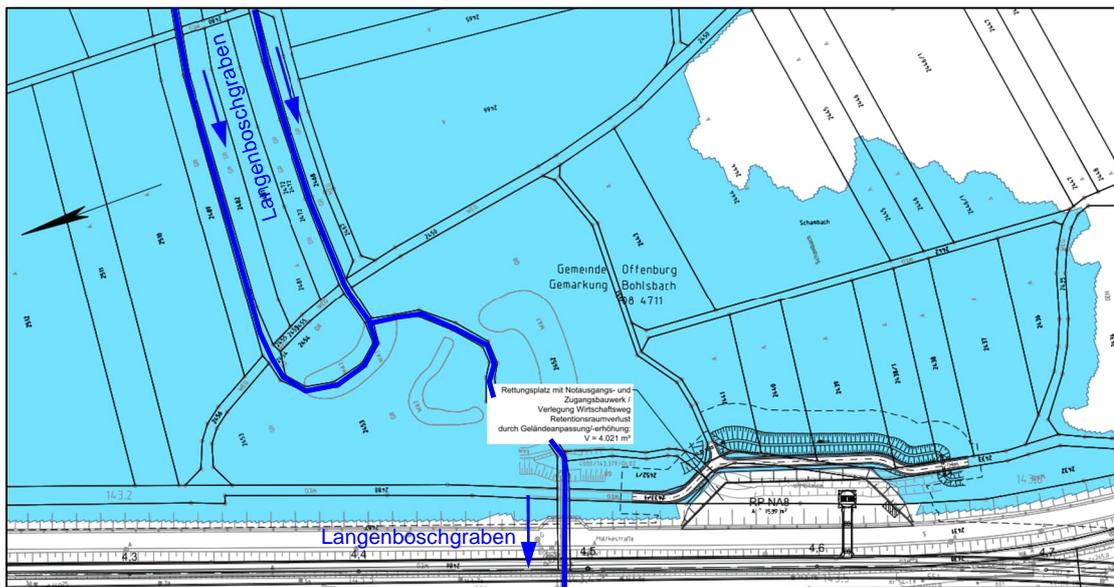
Überflutungsflächen Bereich Langenboschgraben einschließlich der Planung
